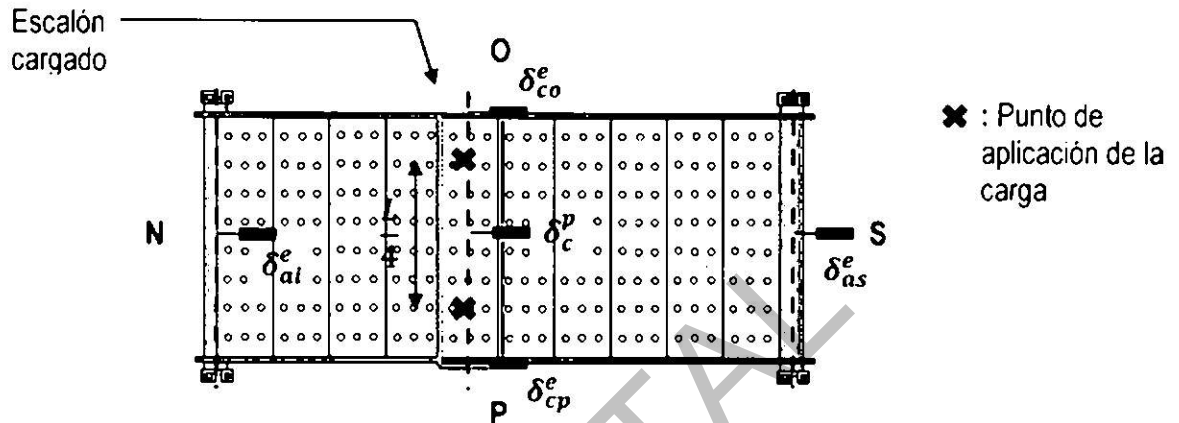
Esquema del montaje del ensayo de flexión al centro de la escala (Vista en planta).
